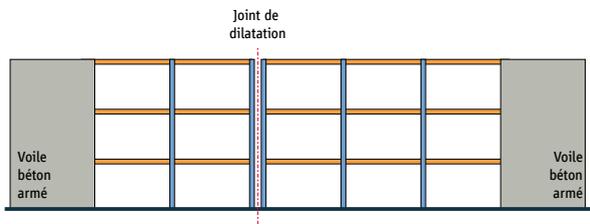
Bâtiment contreventé par deux noyaux en béton et avec joint de dilatation
